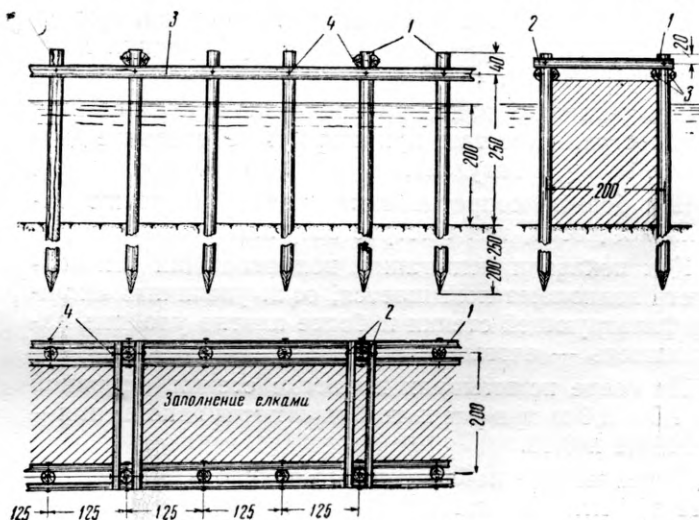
Конструктивный чертеж свайного фильтрующего волнолома:
